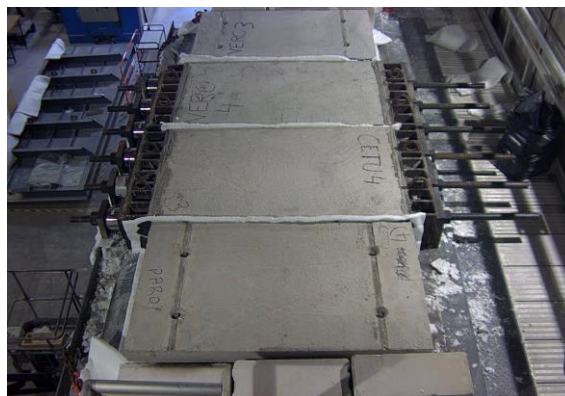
Implantation des dalles sur le four. Etanchéité assurée par de laine minérale
